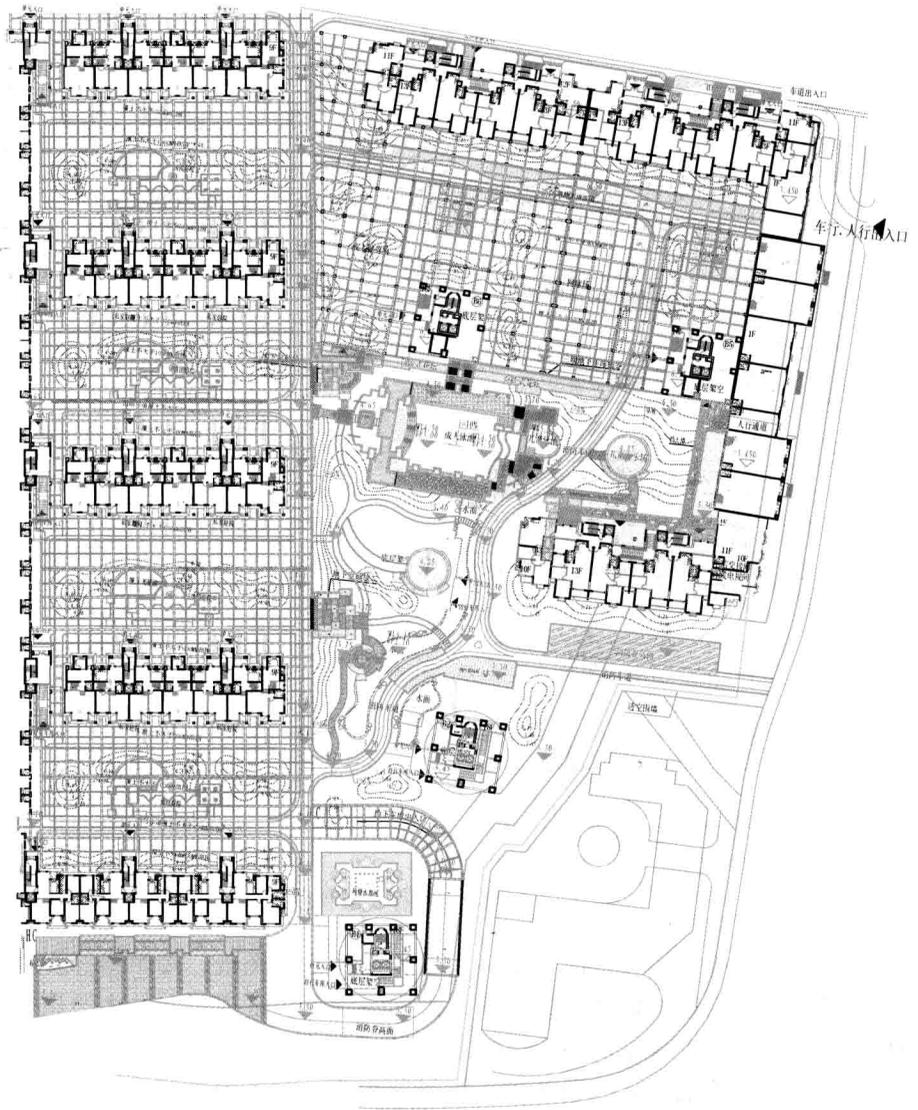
吴徐住宅小区园林绿化景观工程设计总平面图
